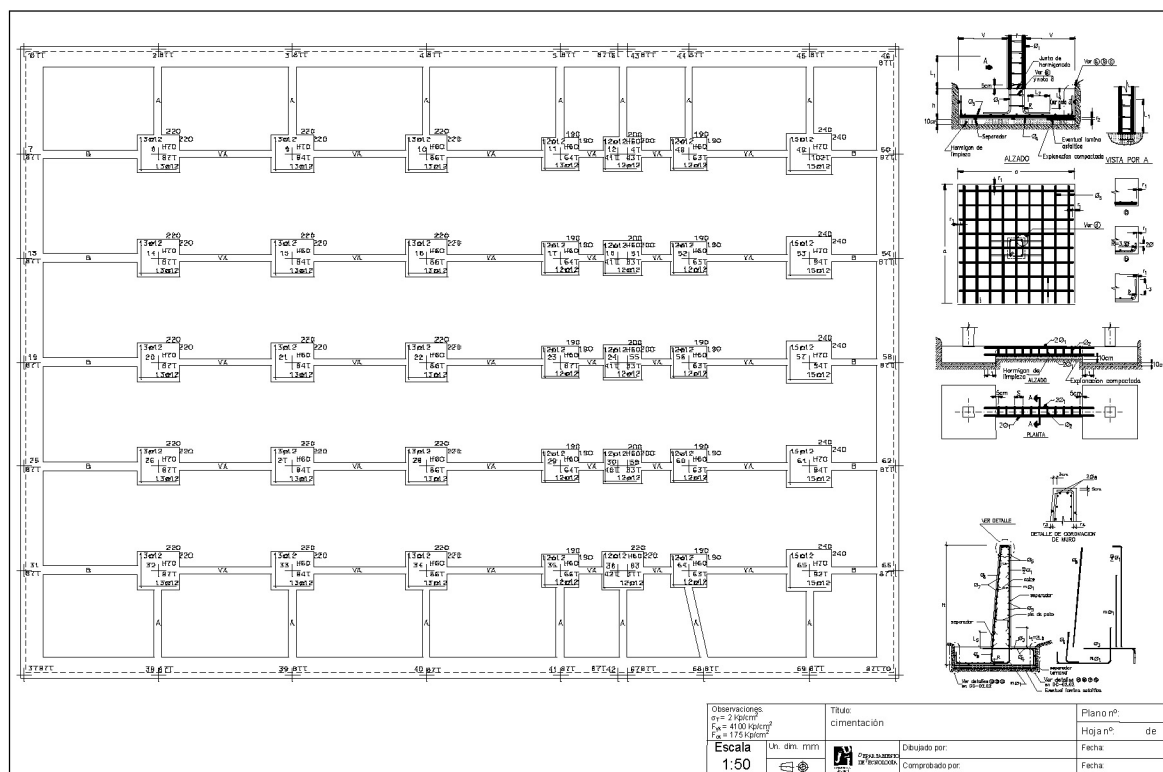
Plano de cimentación con detalles de zapatas, vigas de atado, vigas centradoras y muro
